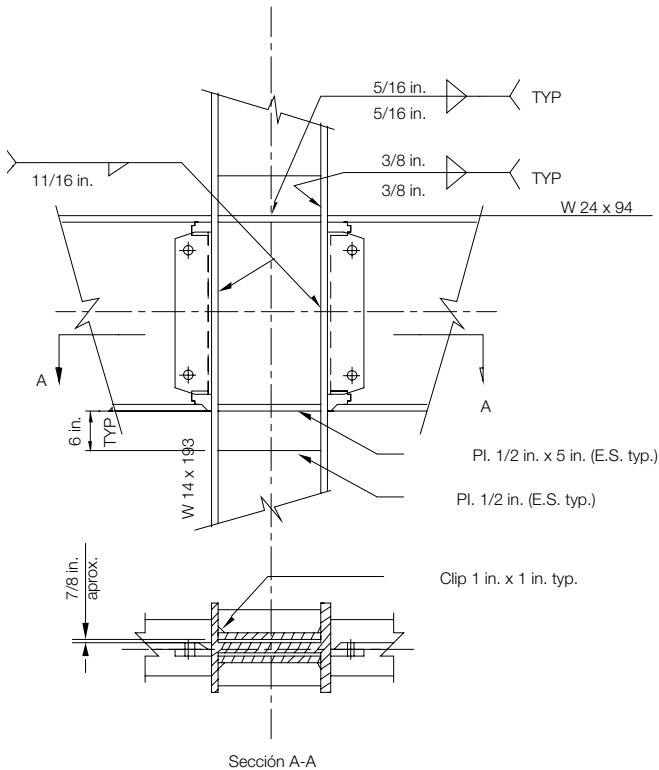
Ejemplo de detalle de placa de refuerzo y atiesadores con soldadura de filete.
